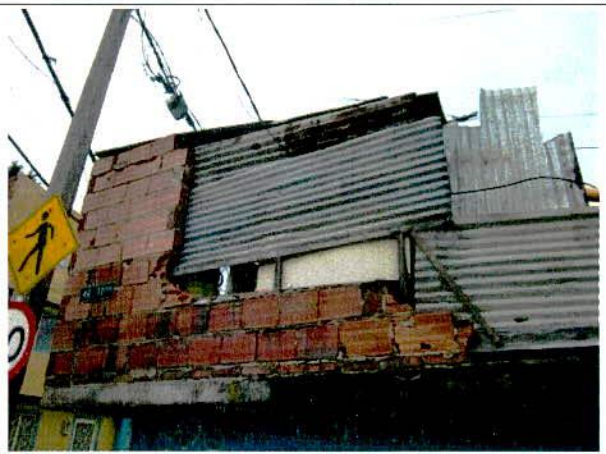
Daño fuerte del muro de fachada del costado oriental.
